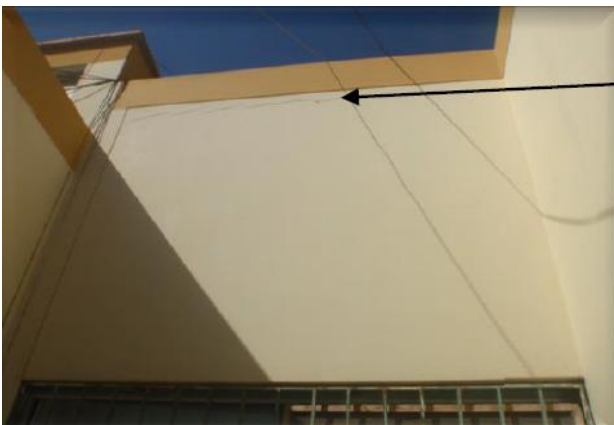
Se observa separación del muro de la viga por asentamiento de la cimentación.
